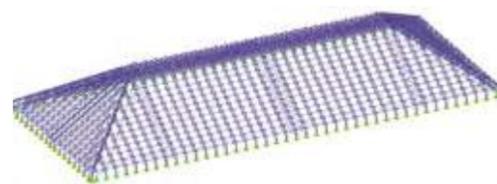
Вариант конструктивного решения ЭКД-Земля в виде пирамиды, прямоугольной в плане
